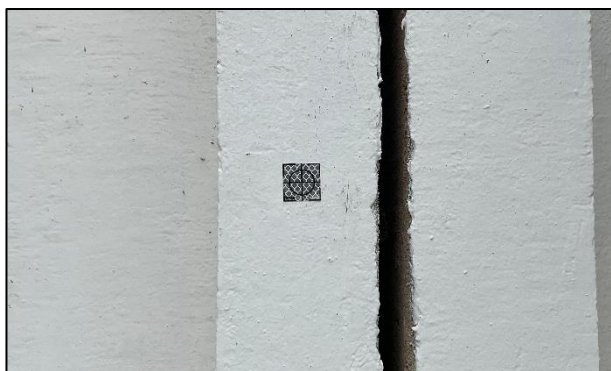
Ponto de apoio fixado na fachada da edificação.
